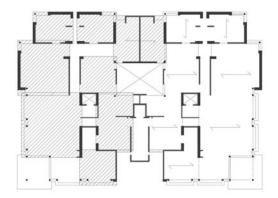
Esquema estructural de la planta tipo edificio c/ Tres Torres de Lluís Nadal, dirección de viguetas y formación de núcleos rígidos con muros en forma de L o U
